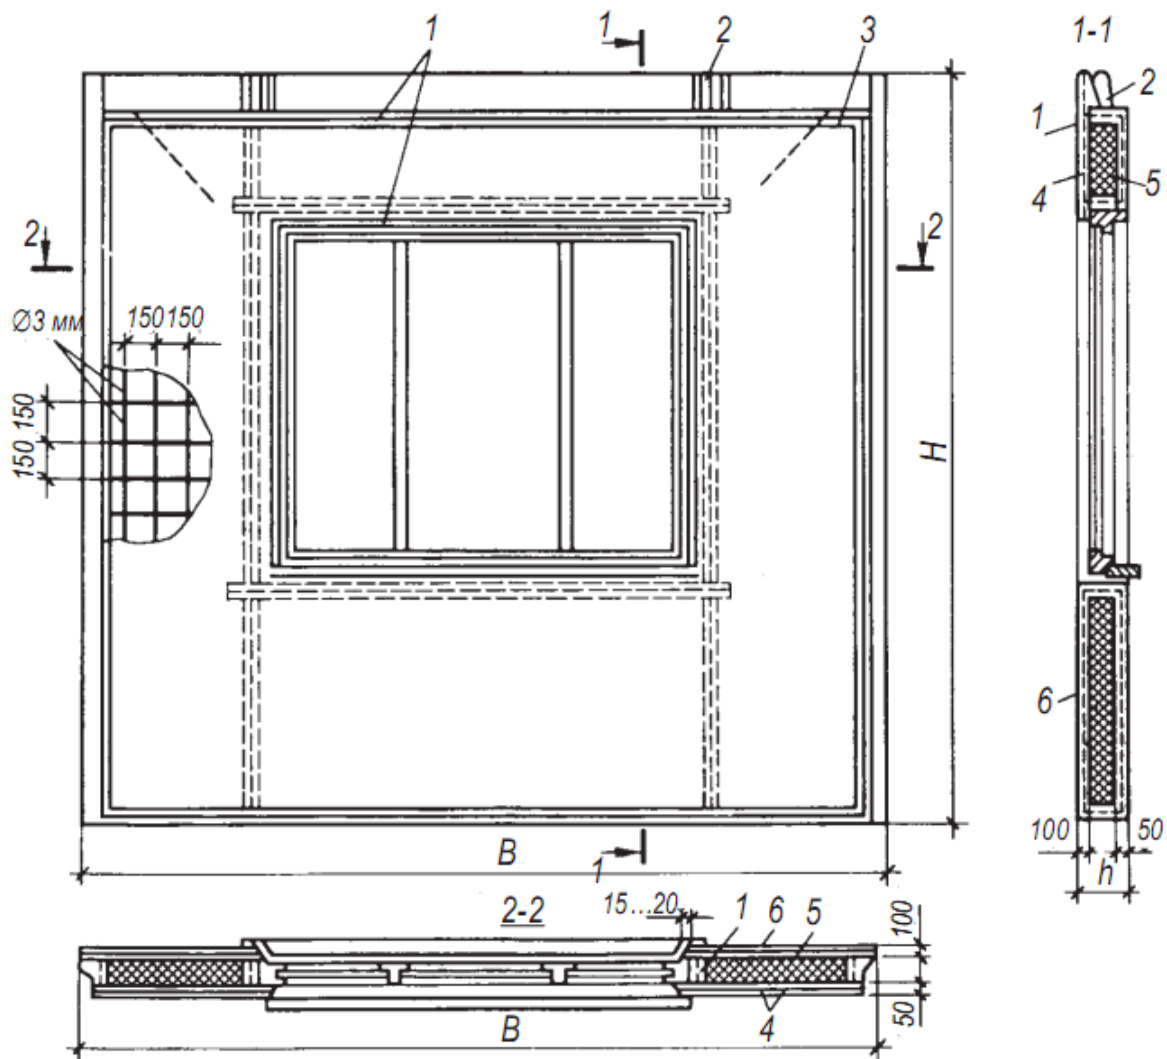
Тришарова стінова панель: 1 – зварні каркаси; 2 – монтажні петлі; 3 – закладні деталі; 4 – арматурні сітки; 5 – утеплювач; 6 – важкий бетон
